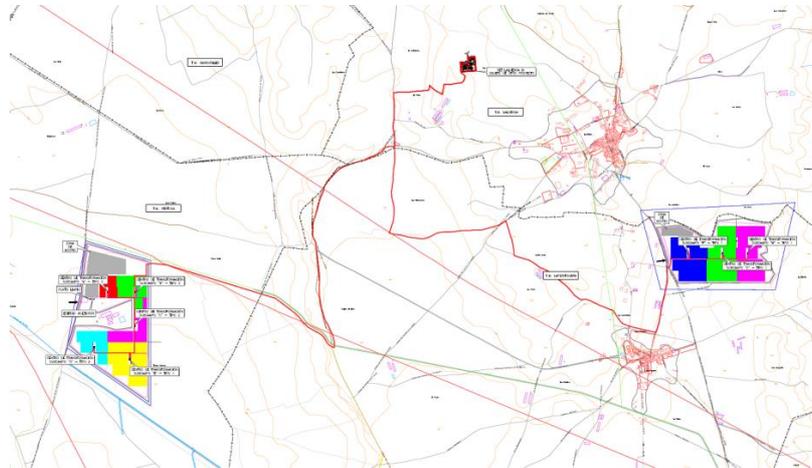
Detalles del proyecto. (Fuente: Anteproyecto)
